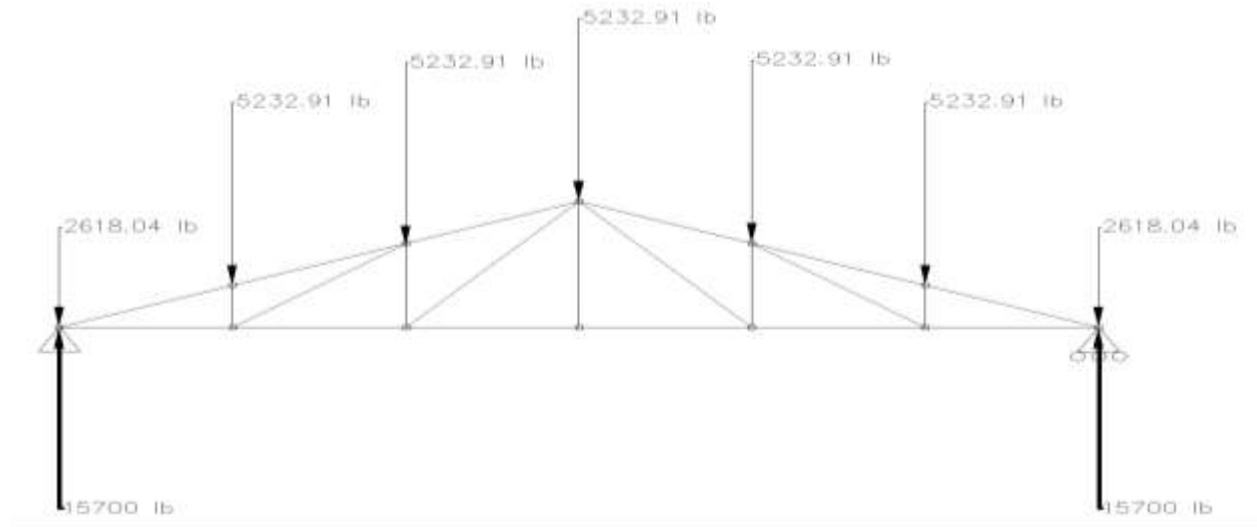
Diagrama donde se muestran reacciones en apoyos en armadura.
